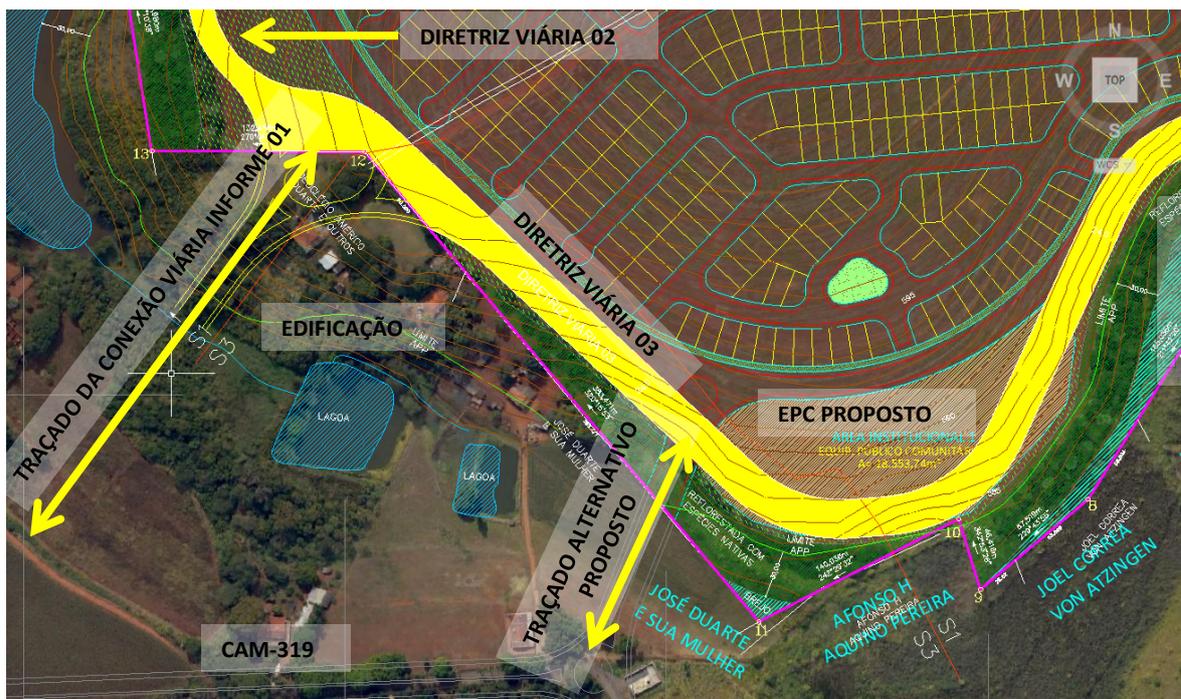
Ilustração demonstrando o traçado indicado na planta do Informe nº 001/2021 e o traçado alternativo proposto no estudo urbanístico.
